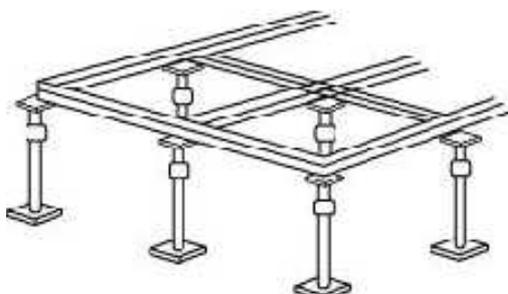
DUCTOS BAJO PISO ELEVADO¹⁸
